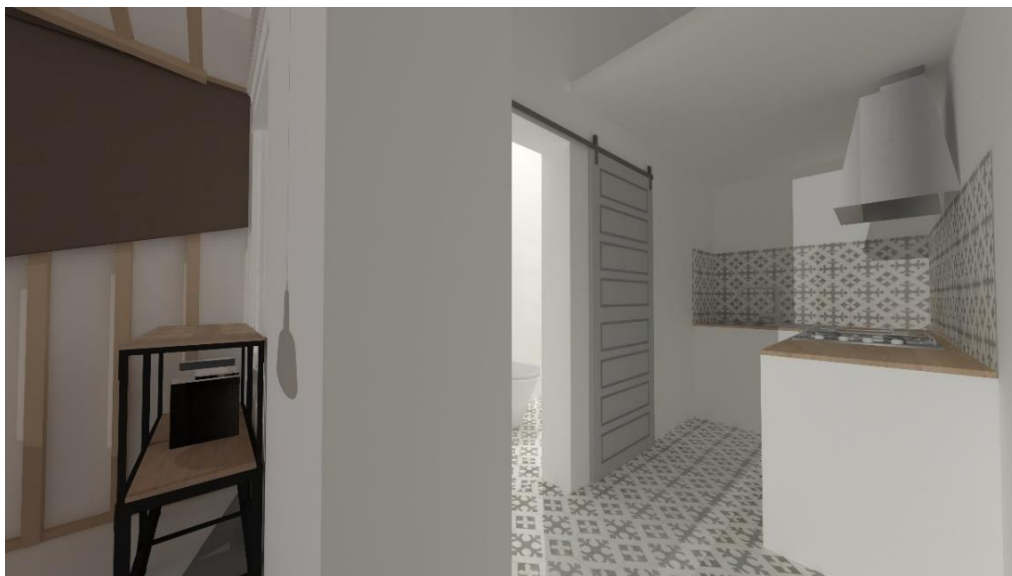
Renders vista estante e estrutura atelier, a cozinha e casa de banho no atelier.
